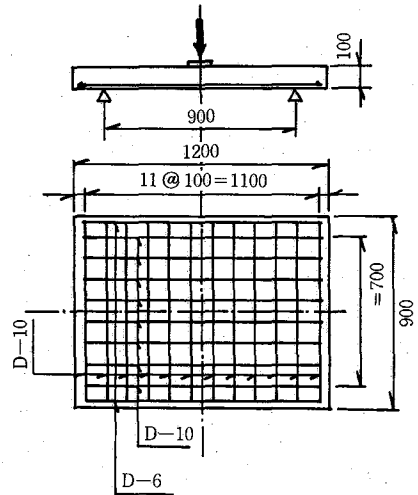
鉄筋コンクリート床版 (1 方向版, H=10 cm)
